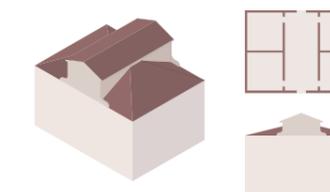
Isonometria, pianta e prospetto del modello di Villa a corpo singolo
